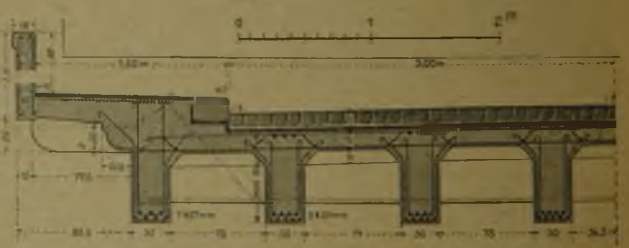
4. Aspacher Brücke über die Murr in Backnang. Erbaut 1911.
